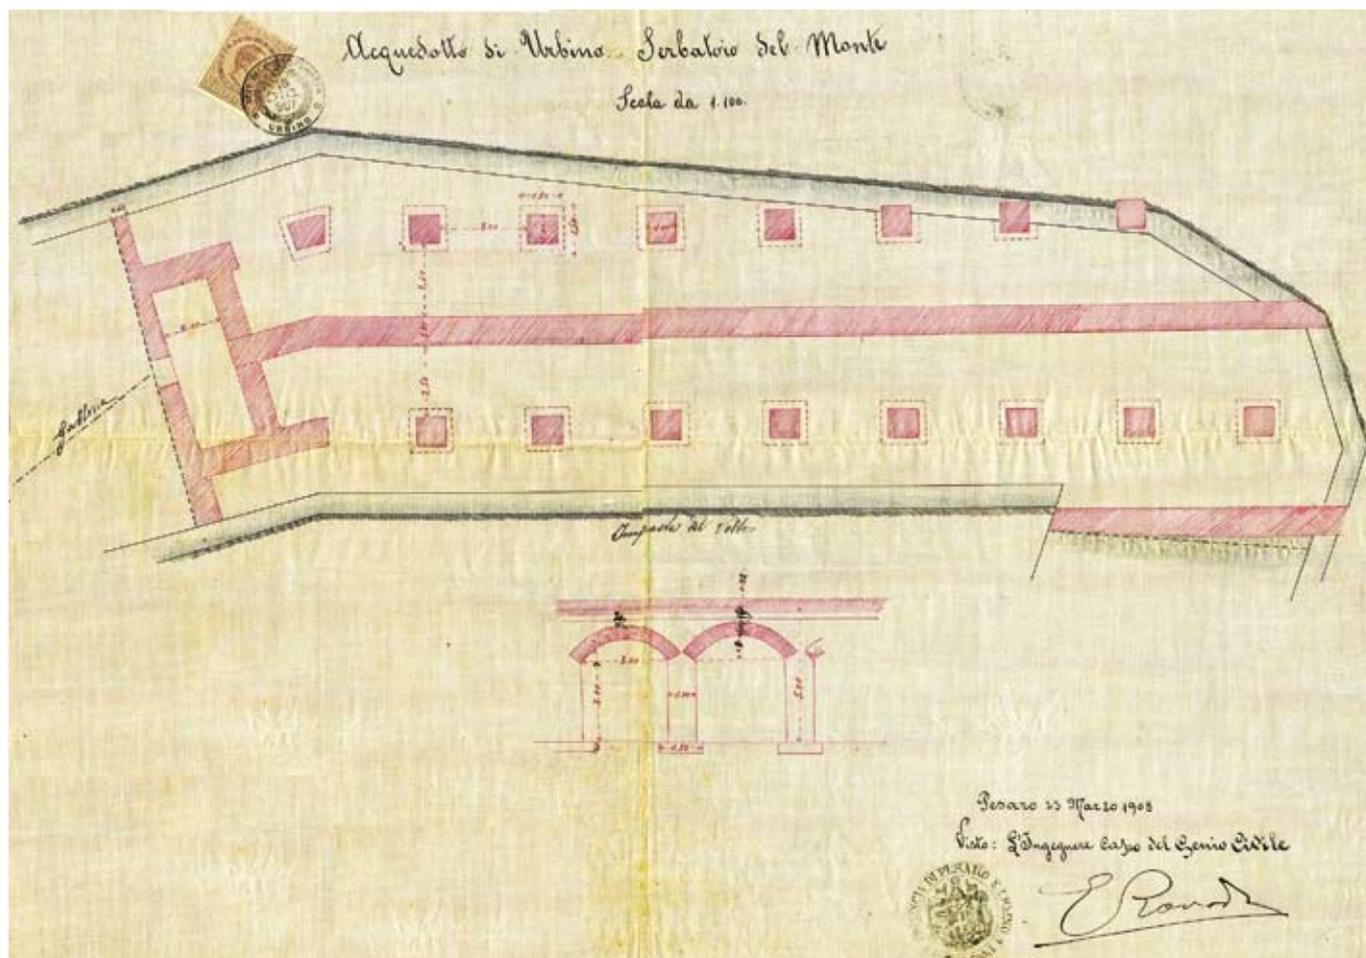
Planimetria delle cisterne del Monte (per gentile concessione dell'Archivio di Stato Sezione di Urbino).
